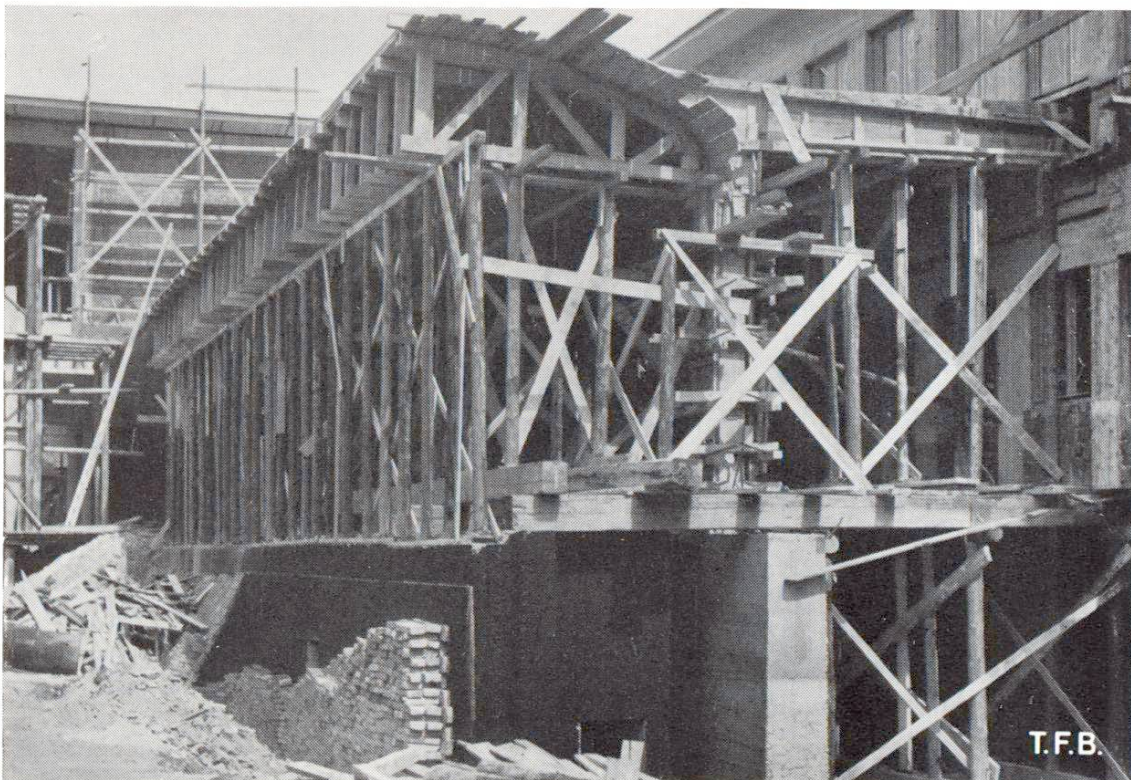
Coffrage de la couverture en avant-toit d'un quai longeant un bâtiment. Au fond, bâtiment administratif avec squelette en béton.
